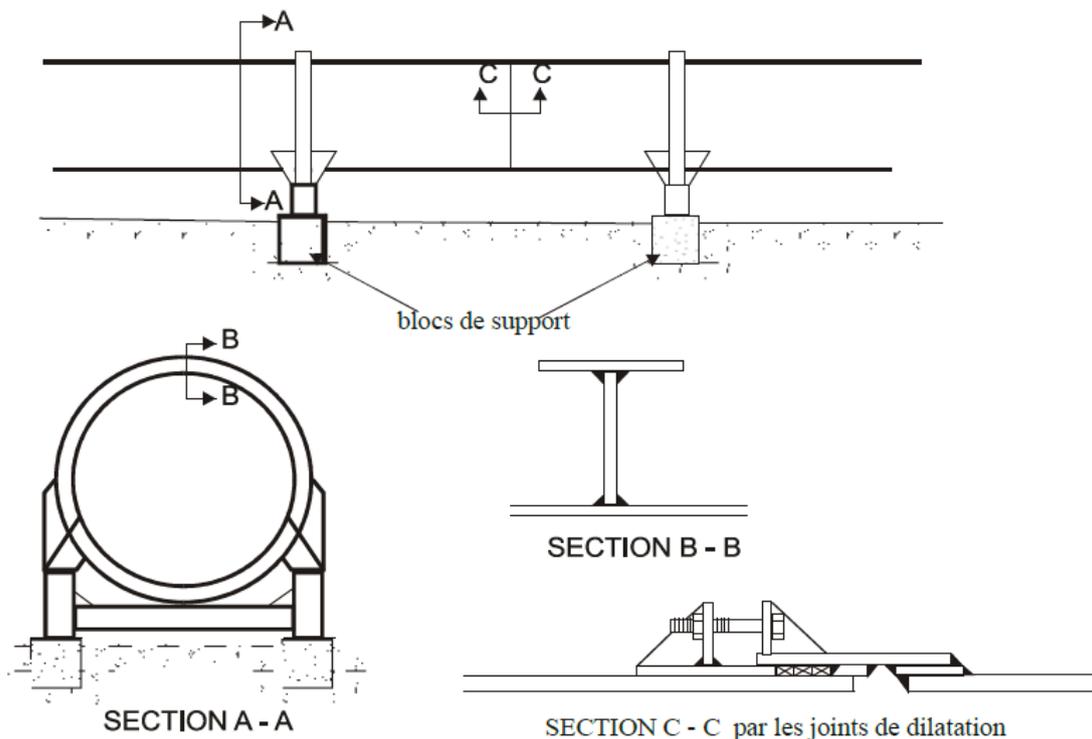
conduite forcée avec blocs d'ancrage en béton et joints de dilatation.
